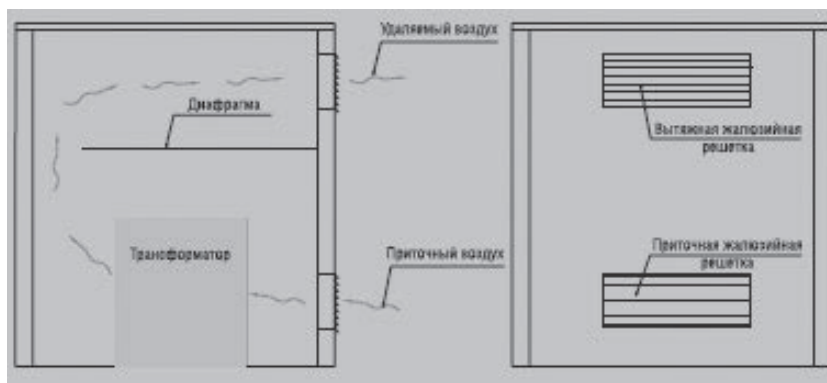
Схема организации естественной вентиляции в помещении трансформаторной: а — разрез; б — фасад
